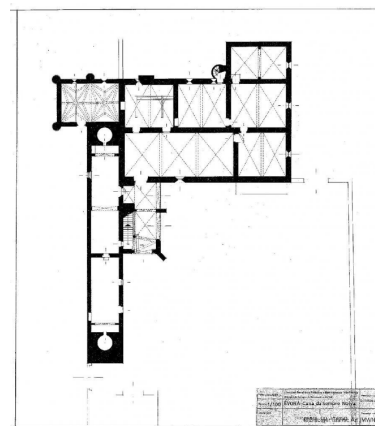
Planta do piso térreo do Paço da Sempre Noiva.
